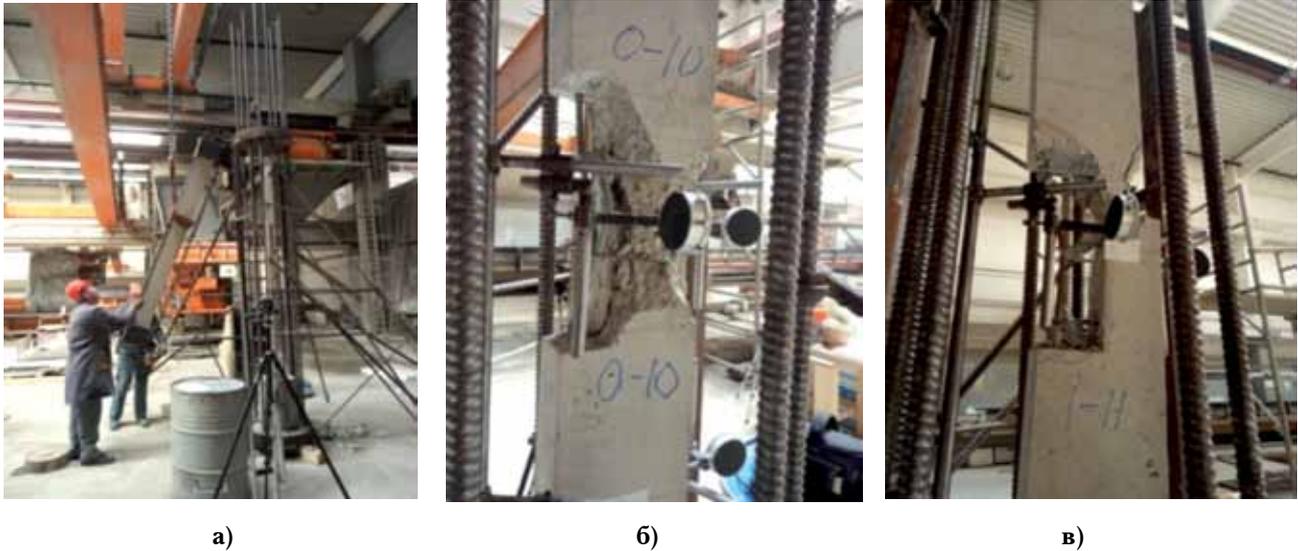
Испытание опытных образцов: а - установка колонны в испытательную клетку; б - процесс испытания; в - разрушенный образец
